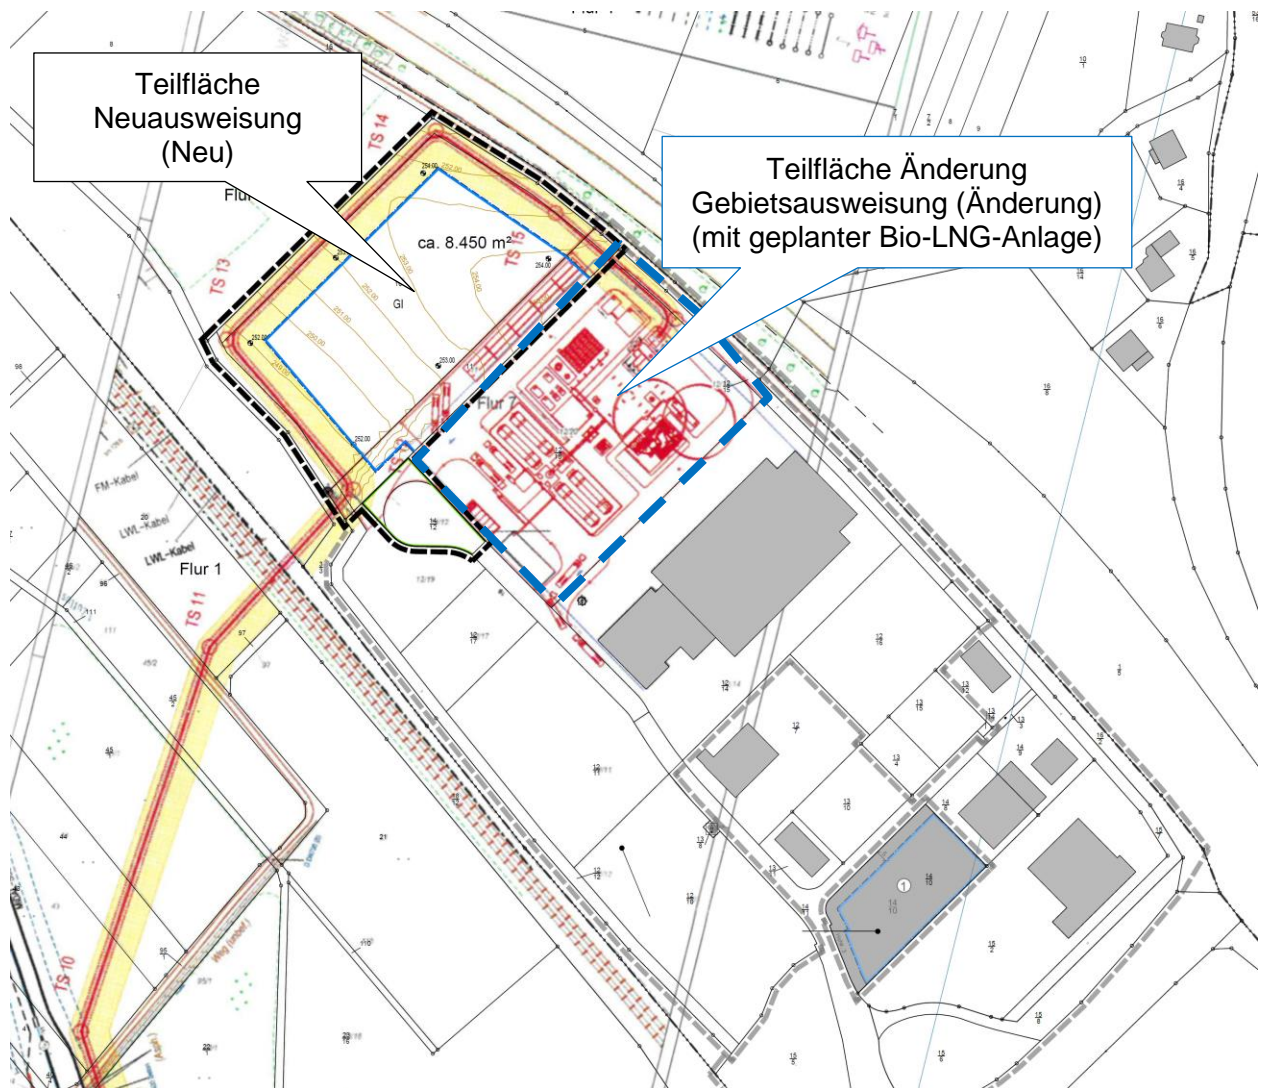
Lageplan mit Kennzeichnung der zu betrachtenden Teilflächen
